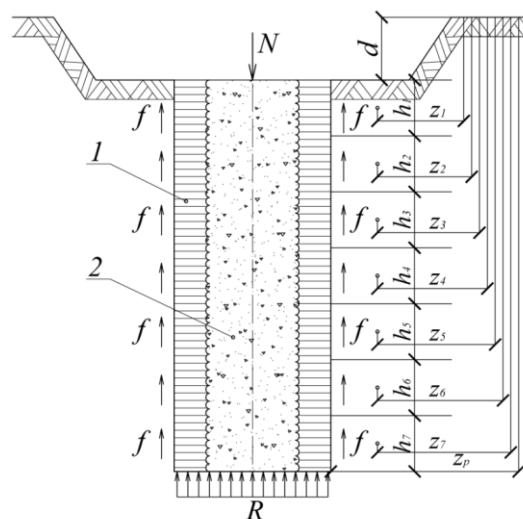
Схема к определению несущей способности сваи SFA (НПШ) совместно с грунтоцементным массивом по грунту (грунтобетонные сваи (ГБС): 1 – грунтоцементный массив, 2 – свая SFA (НПШ)
